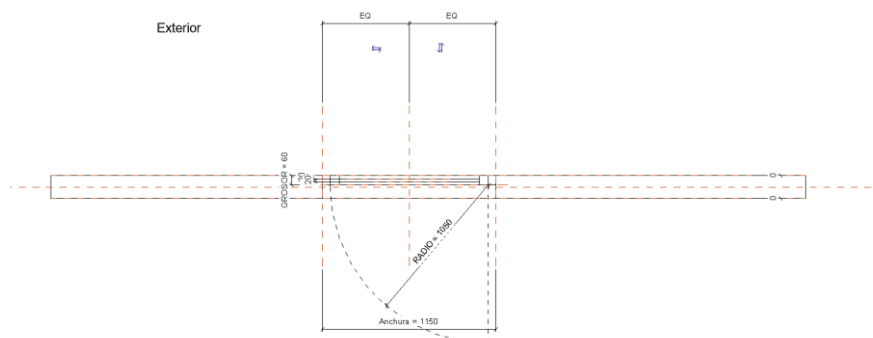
Modelado de puerta con parámetros de anotación. Fuente: ídem anterior
